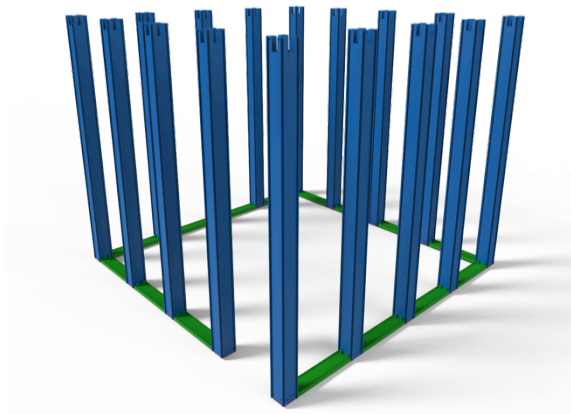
Pilares sobre Base de pilares embona con el rigidizador.
